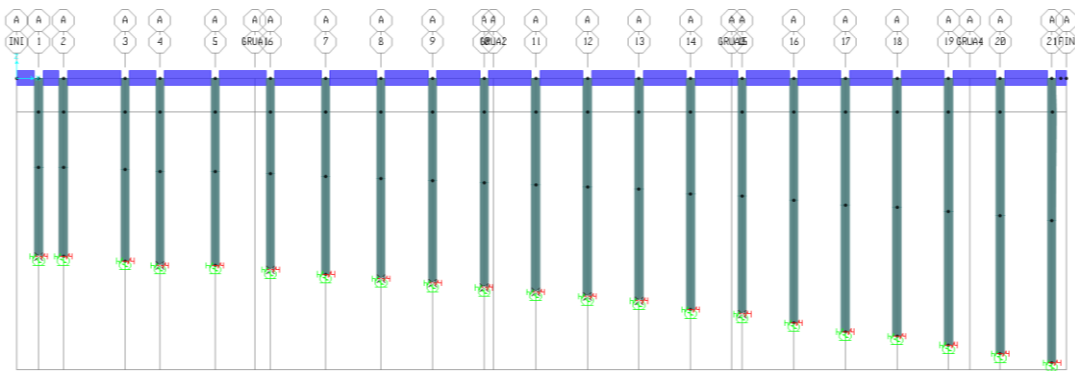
Vista en elevación del plano A de modelación, paralelo a plano X-Vertical'.
